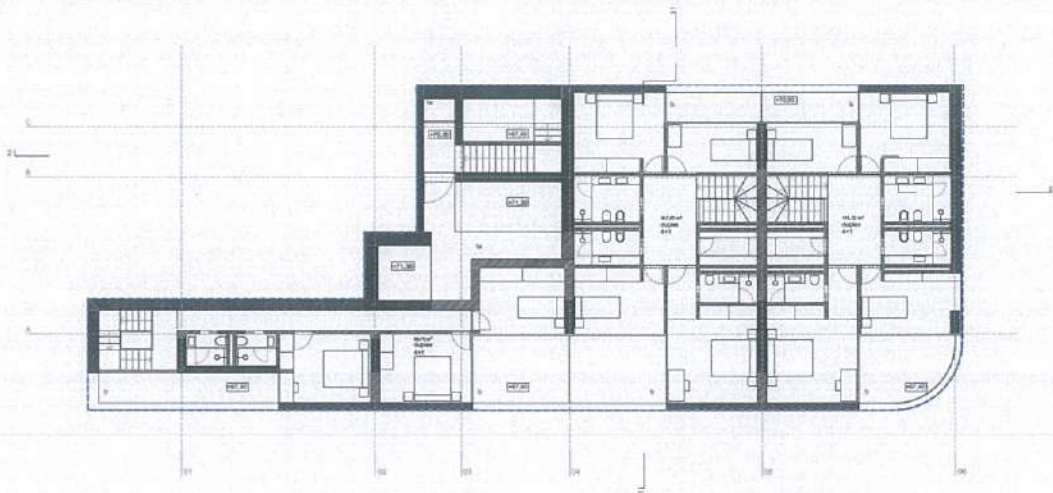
Planimetria e katit TIP te banimit duplex I, kati 22
